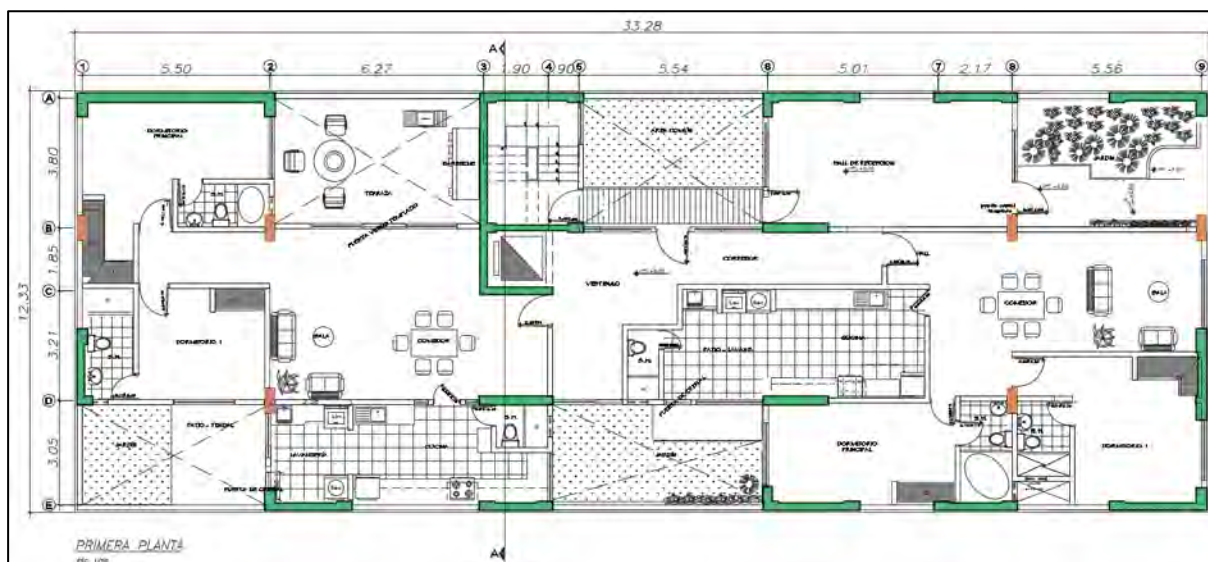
Plano de Arquitectura - Primera planta, escala 1/50 con elementos estructurales resaltados.
